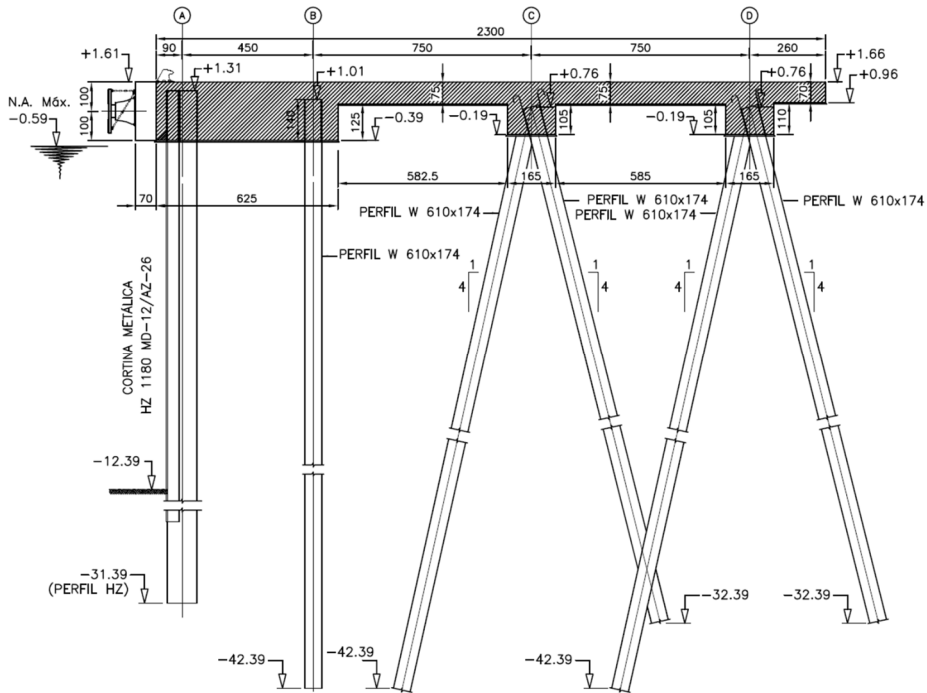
Corte transversal da estrutura. Dimensões em centímetro, níveis em metro.
